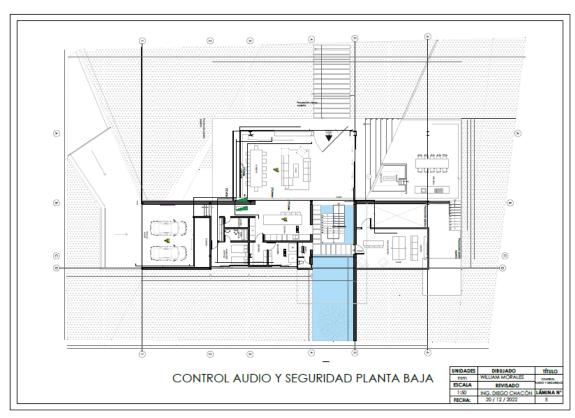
Plano del diseño de control de audio y seguridad con Loxone planta baja.
